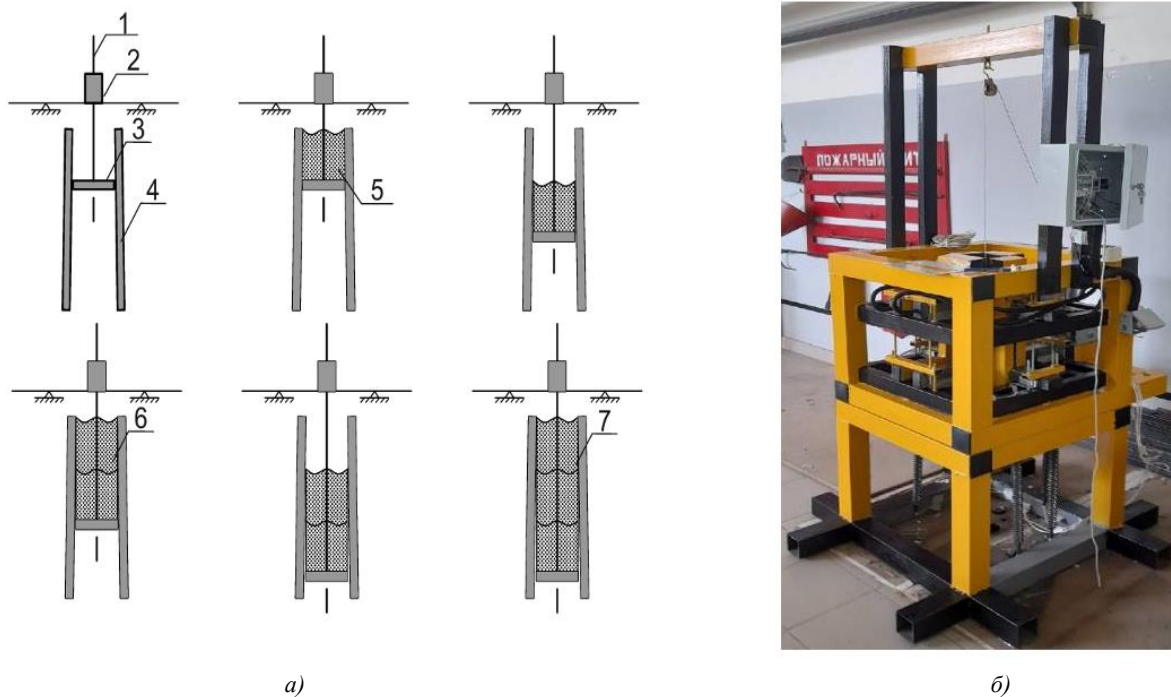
а) способ формирования железобетонных конструкций посредством опускающегося бетона (патент 2566540):
